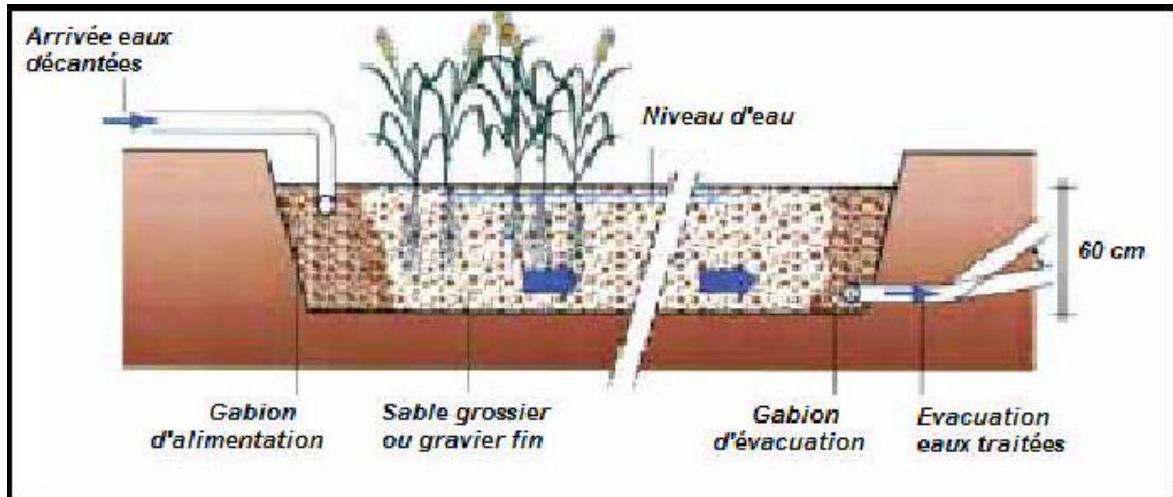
Coupe transversale d'un filtre planté à écoulement horizontal
